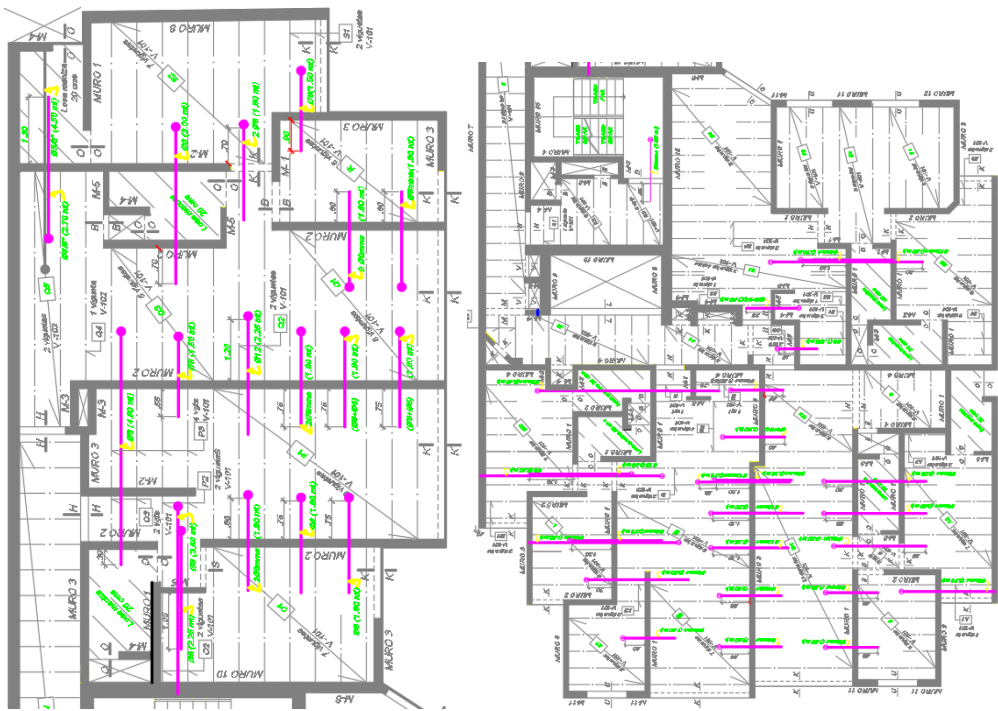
Plano distribución acero negativo- Sistema viguetas Pretensadas
